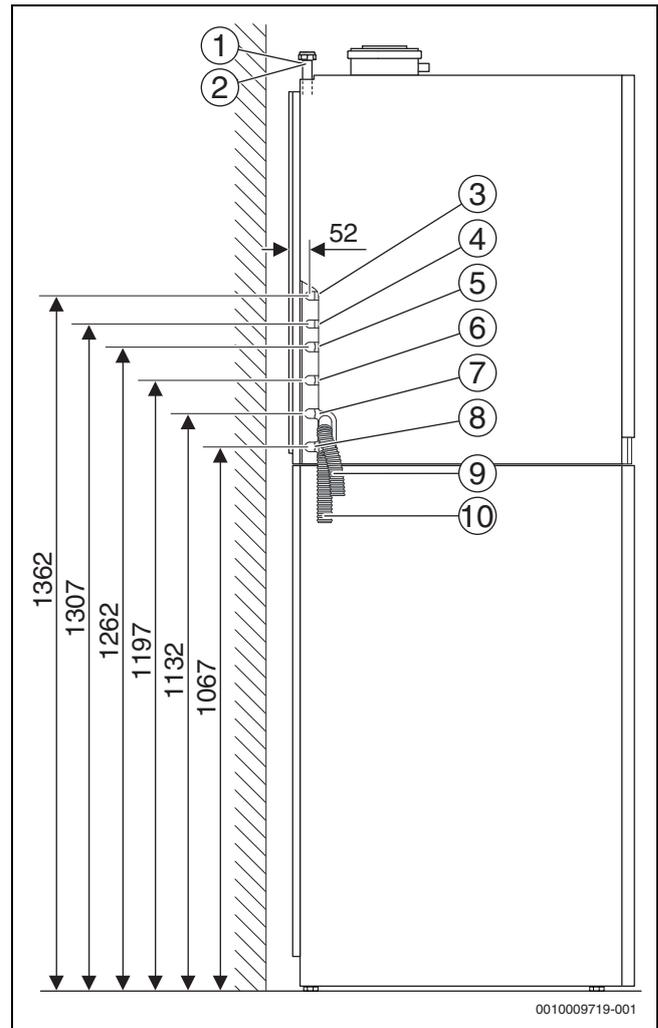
Anschlussmaße des Zubehörs AS-H1/Horizontales Anschluss-Set (Maße in mm)
